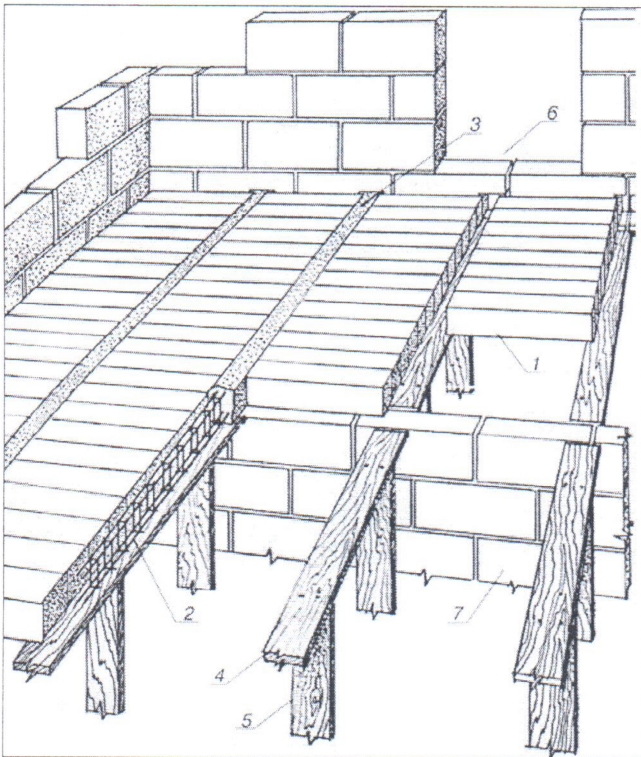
Сборно-монолитное перекрытие из мелких газобетонных блоков: 1 – мелкие газобетонные блоки; 2 – арматурный каркас с рабочей арматурой; 3 – монолитный шов из раствора класса В 10–15; 4 – доска опалубки; 5 – стойка под опалубку; 6 – дверной проем на балкон; 7 – внутренняя стена
